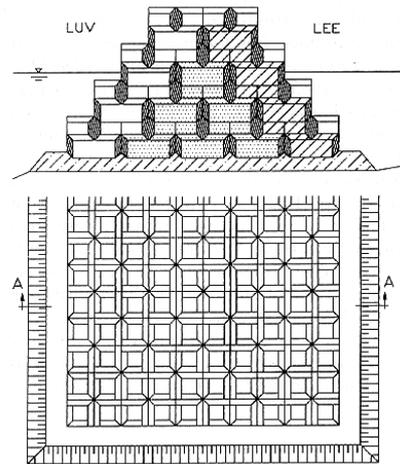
Aus durchströmbaren Betonformkörpern bestehendes wellenbrecherartiges Bauwerk
